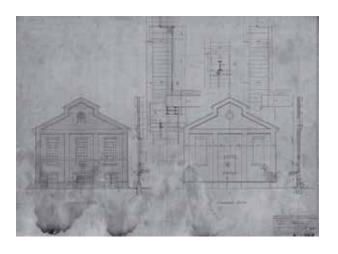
Plano A-868 Proyecto para la Nueva Planta Eléctrica Casa, mostrando las fachadas oeste y este. Sin fecha, contrato núm. 28646. AHF.
